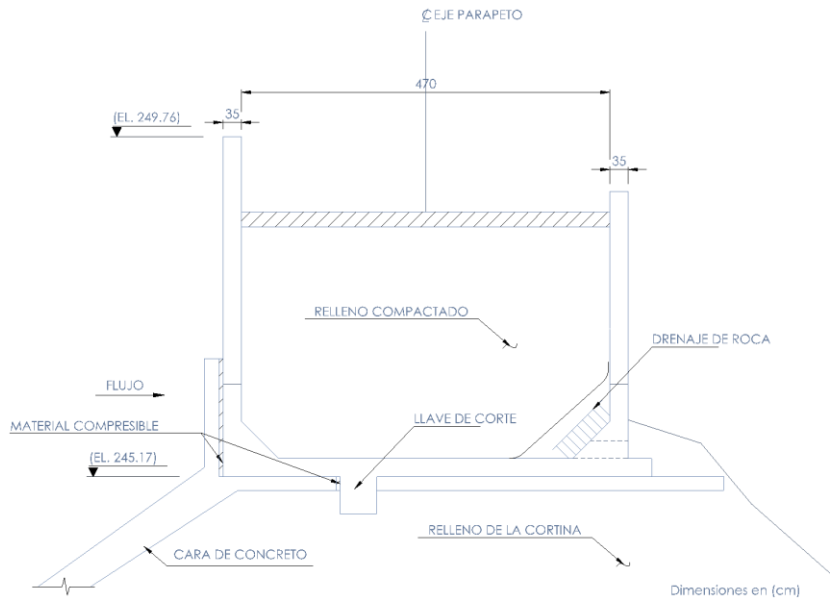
Esquema de parapeto para la presa Kangaroo Creek, Australia de ECCC
